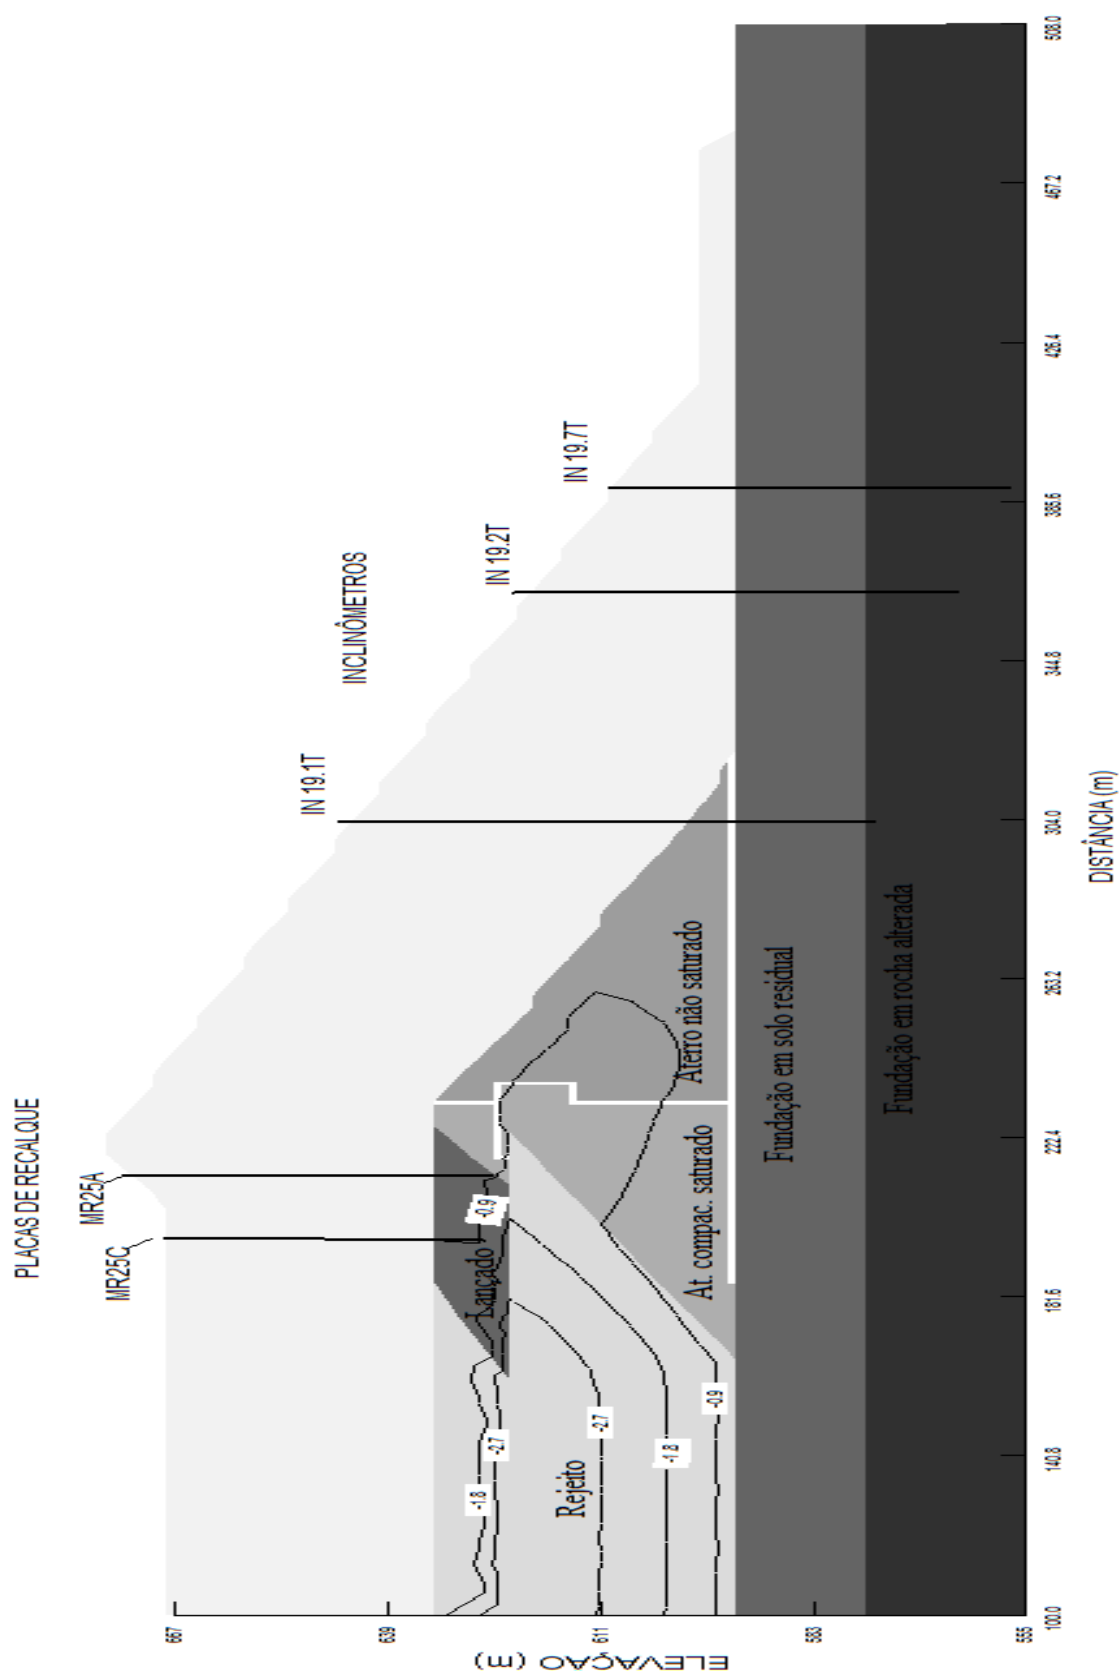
Deslocamentos verticais nas etapas de alteamento 8 a 10 (m) Fonte: O Autor
